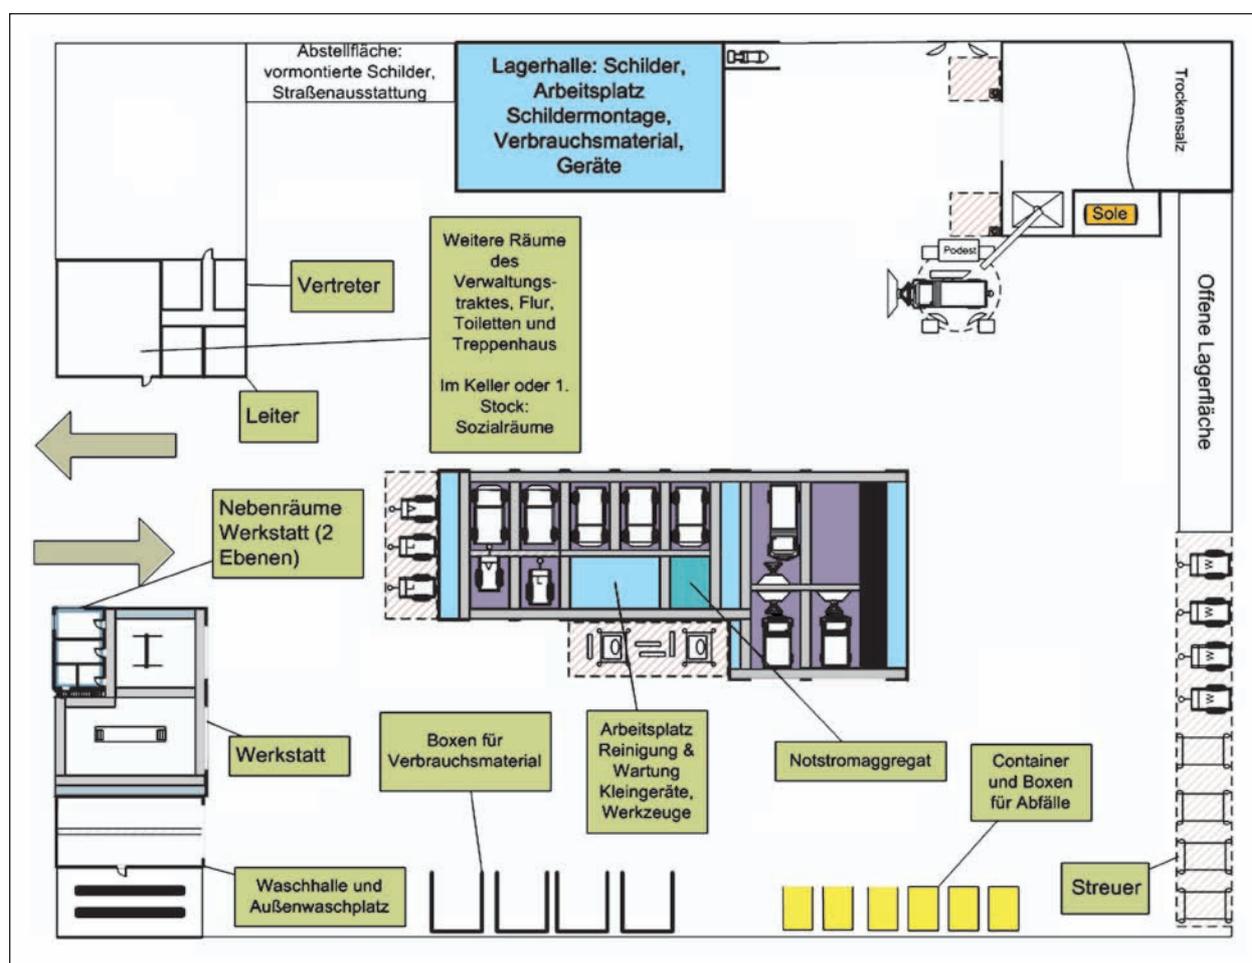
Beispiellayout einer Straßenmeisterei mit kompakter Fahrzeughalle
